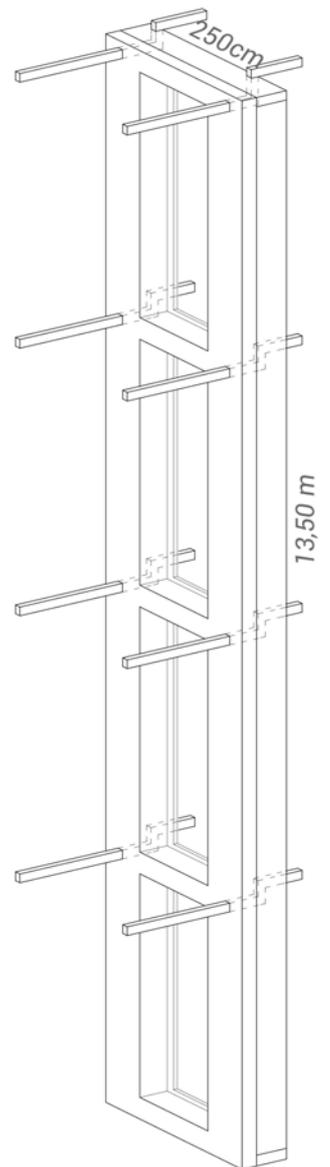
Vorfertigung der Außenwandelemente; © Bernhard Bauer
